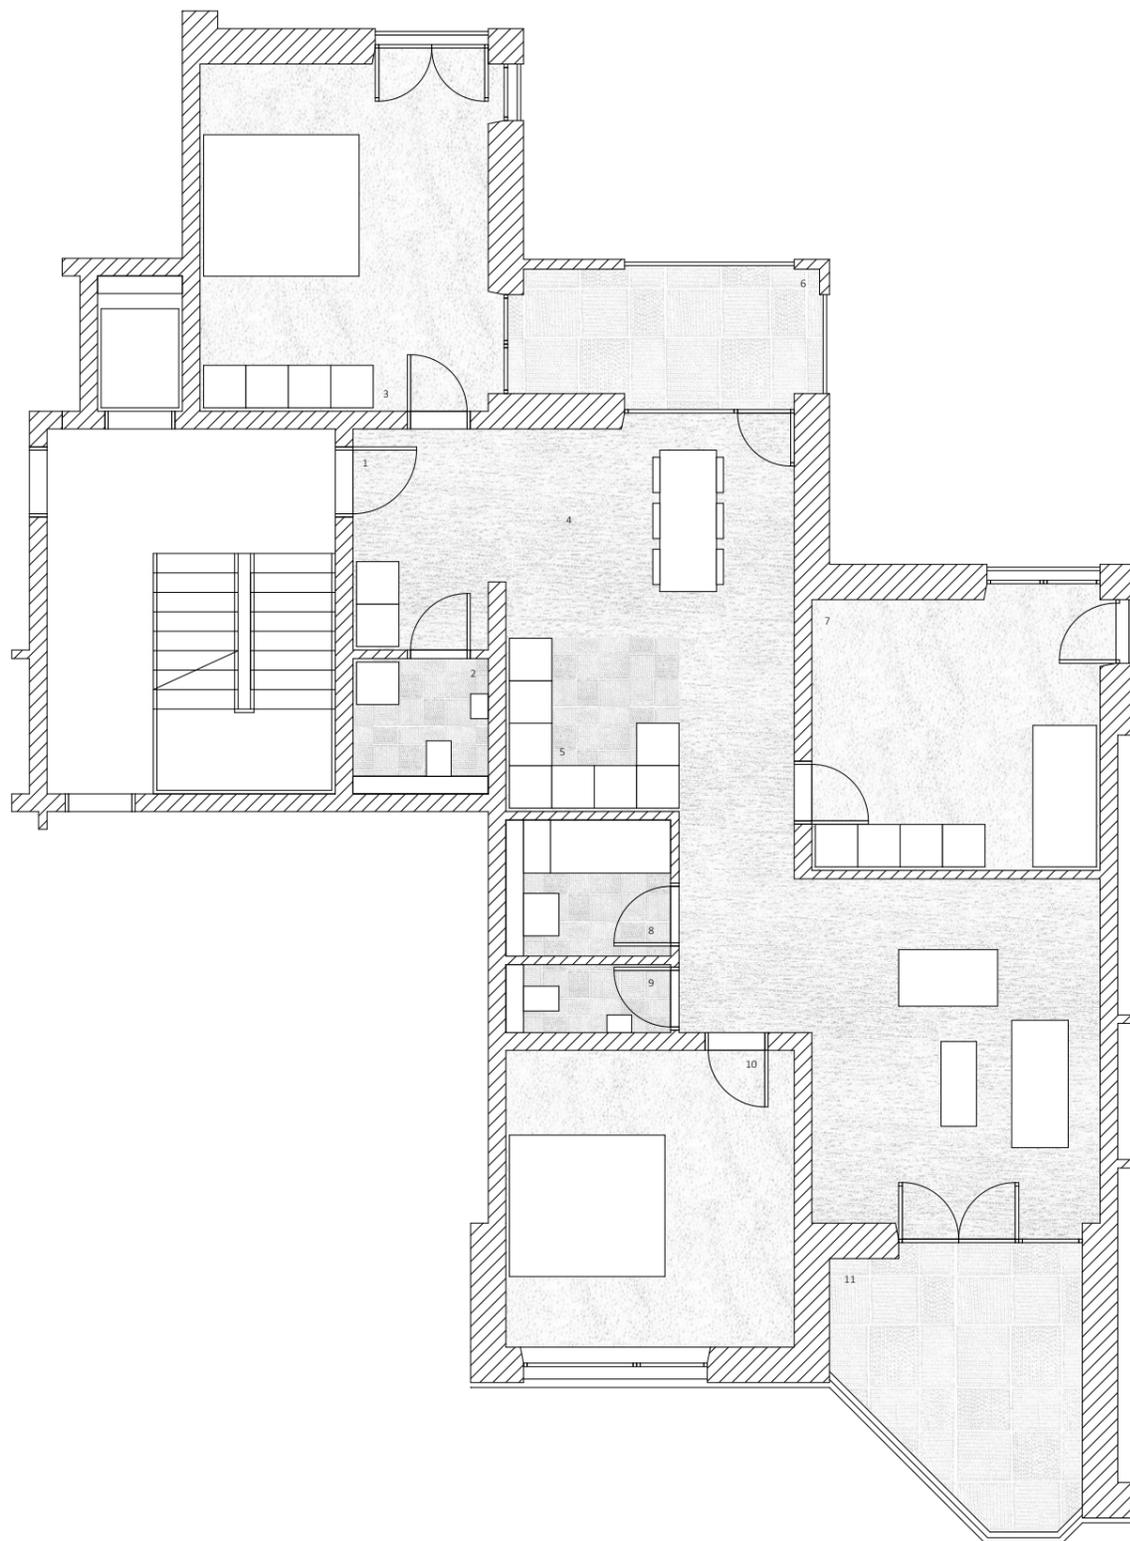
Grundriss Wohnung 4/ Stiege 2
